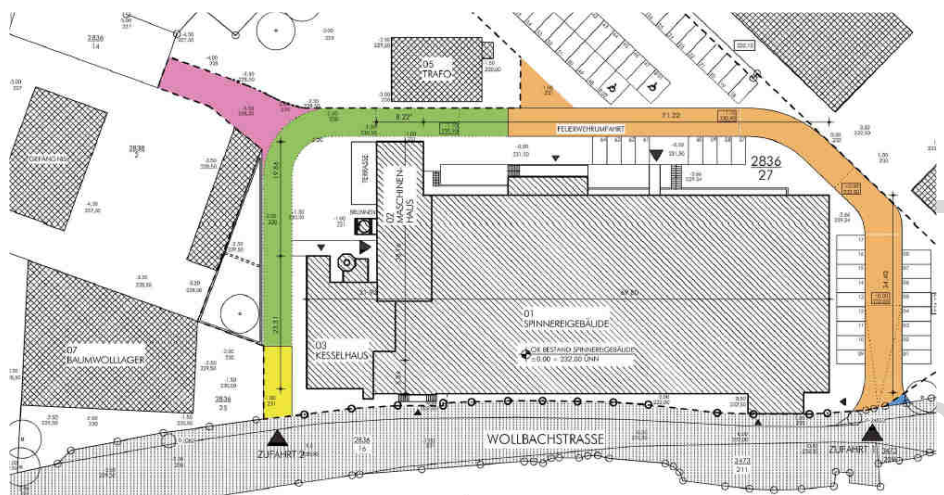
Übersicht Lageplan Gehrechte, Geh-/Fahrrechte, Feuerwehrumfahrtsrechte (Dienstbarkeiten)
